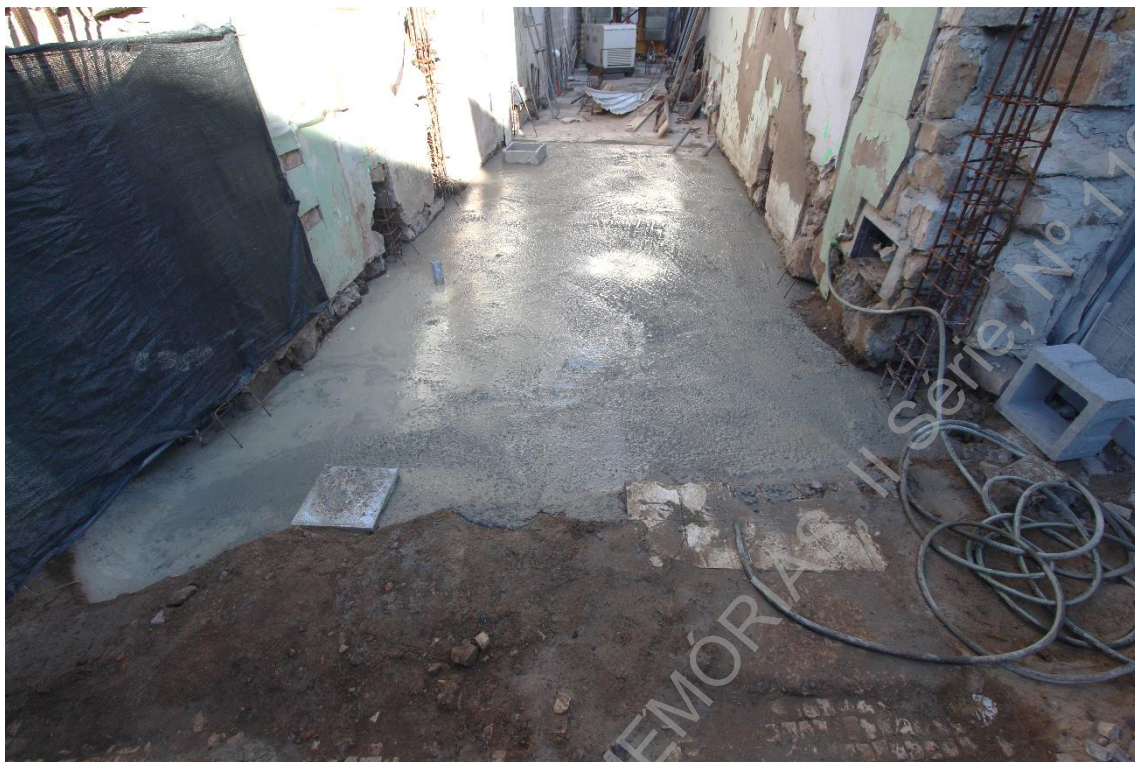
(IMG_1727) – Perspetiva geral da conclusão da betonagem da área intervencionada.
